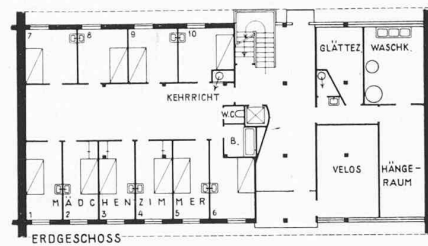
bis 5. Grundrisse 1 : 400.
